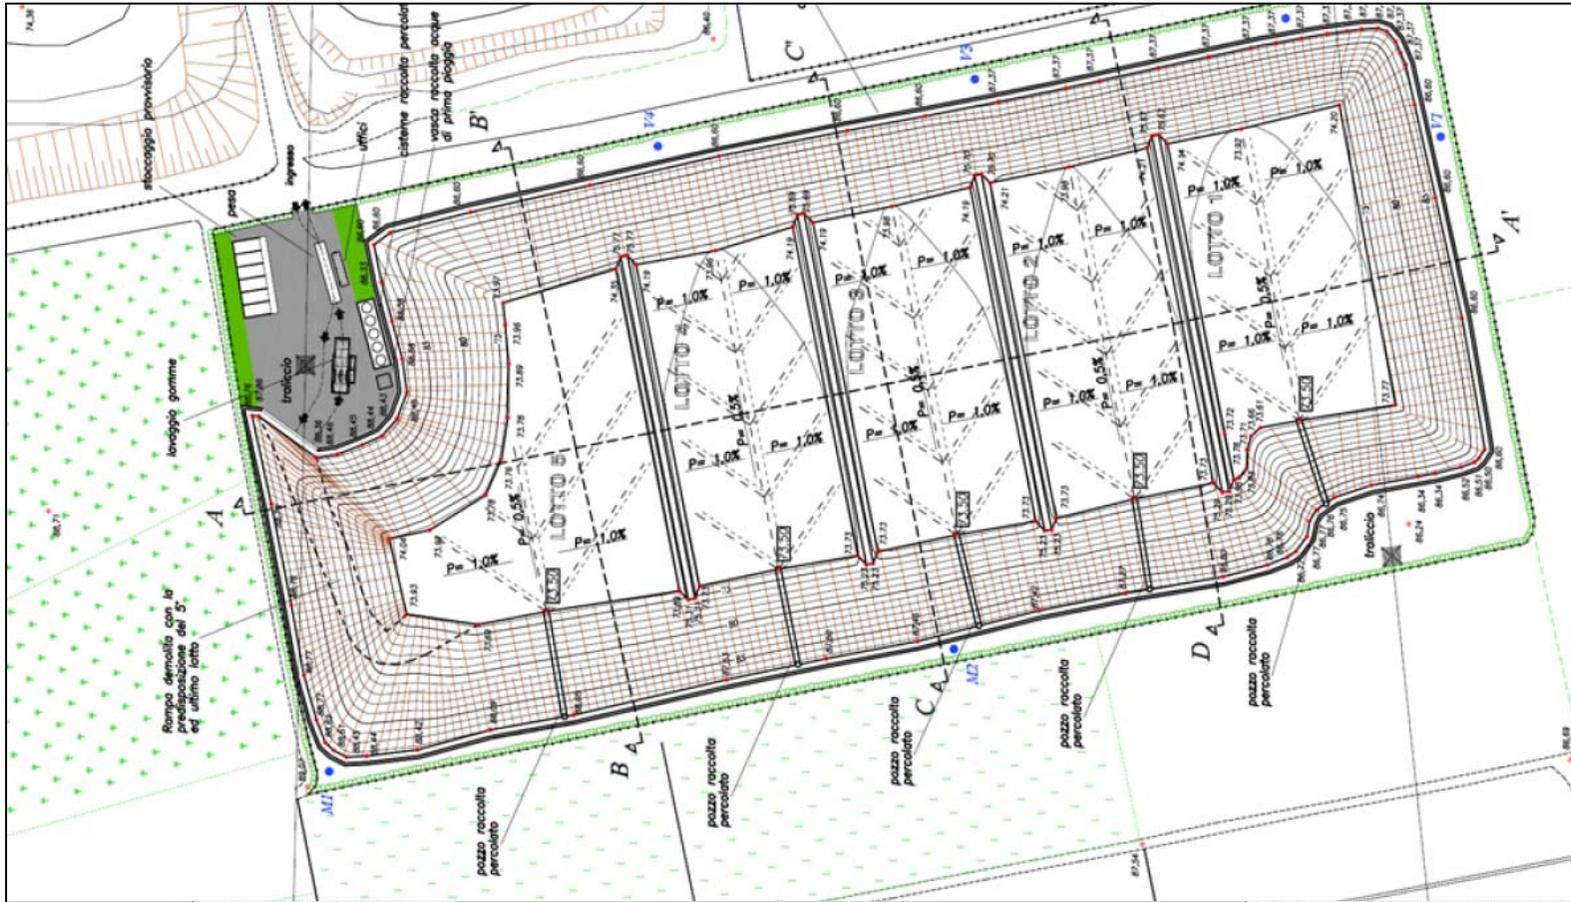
Planimetria generale con Piano di posa rifiuti – Figura estratta dal doc. 10 di tab. 1.1
